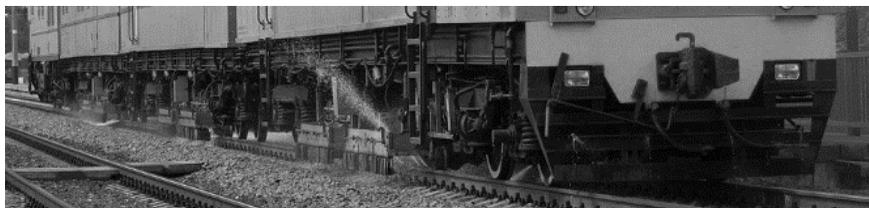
Рельсошлифовальный поезд РШП-48
